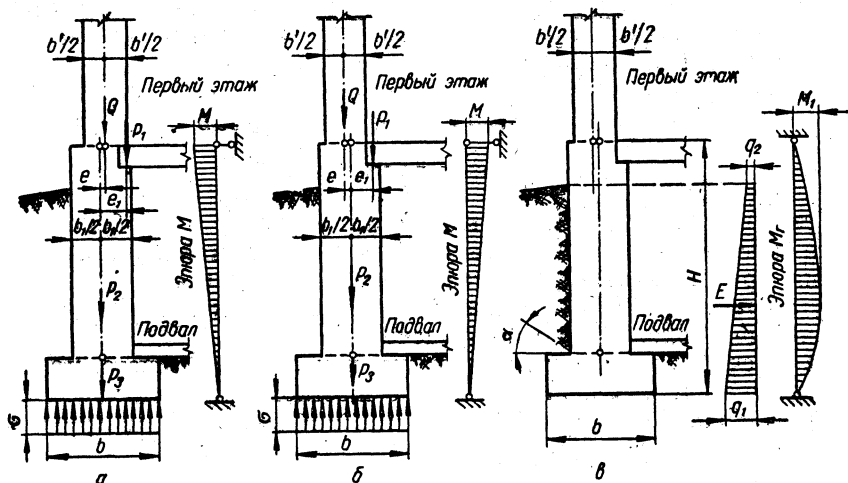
Расчетные схемы фундаментов зданий с подвалом при жесткой конструктивной схеме:
